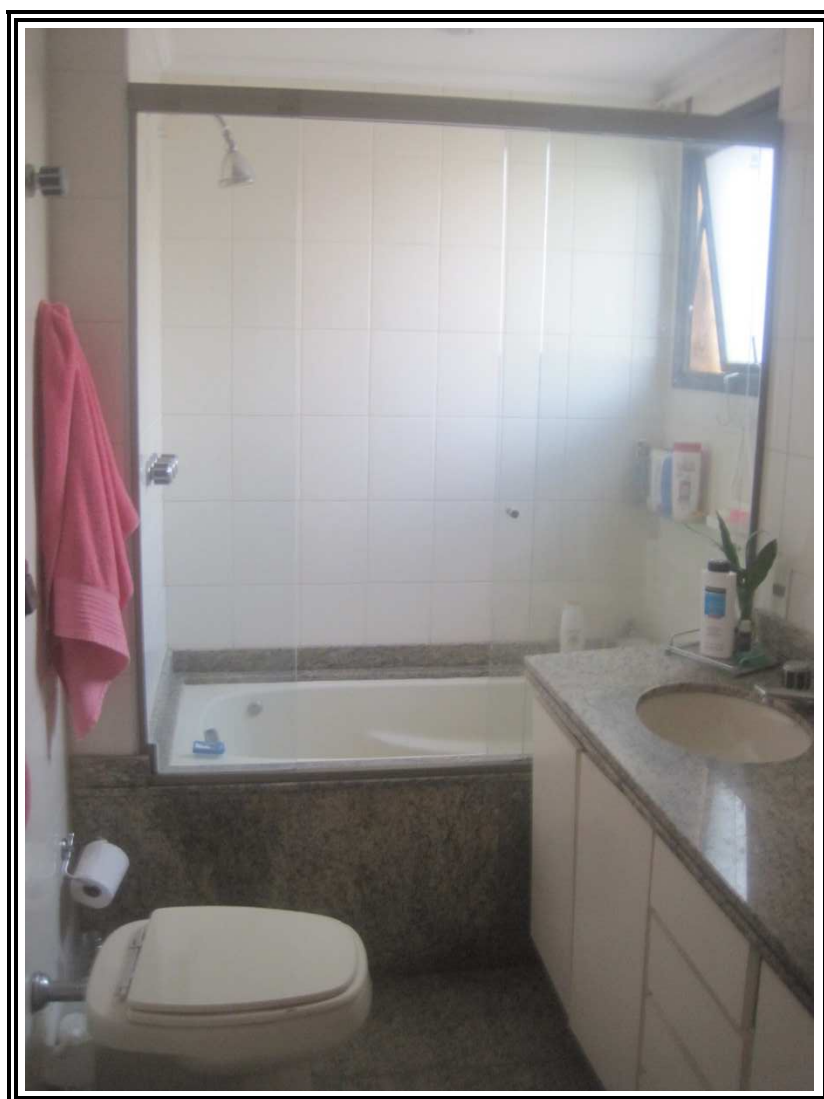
Vista do banheiro do dormitório 01 (suíte máster)
